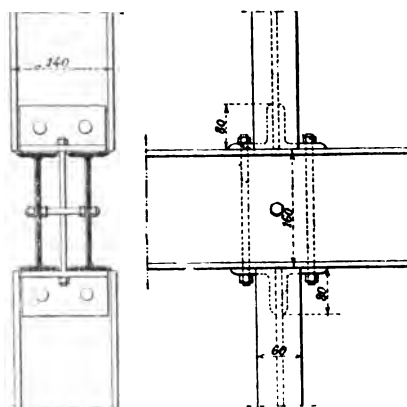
Assemblage du poteau montant d'un pan de fer sur sablière horizontale.
